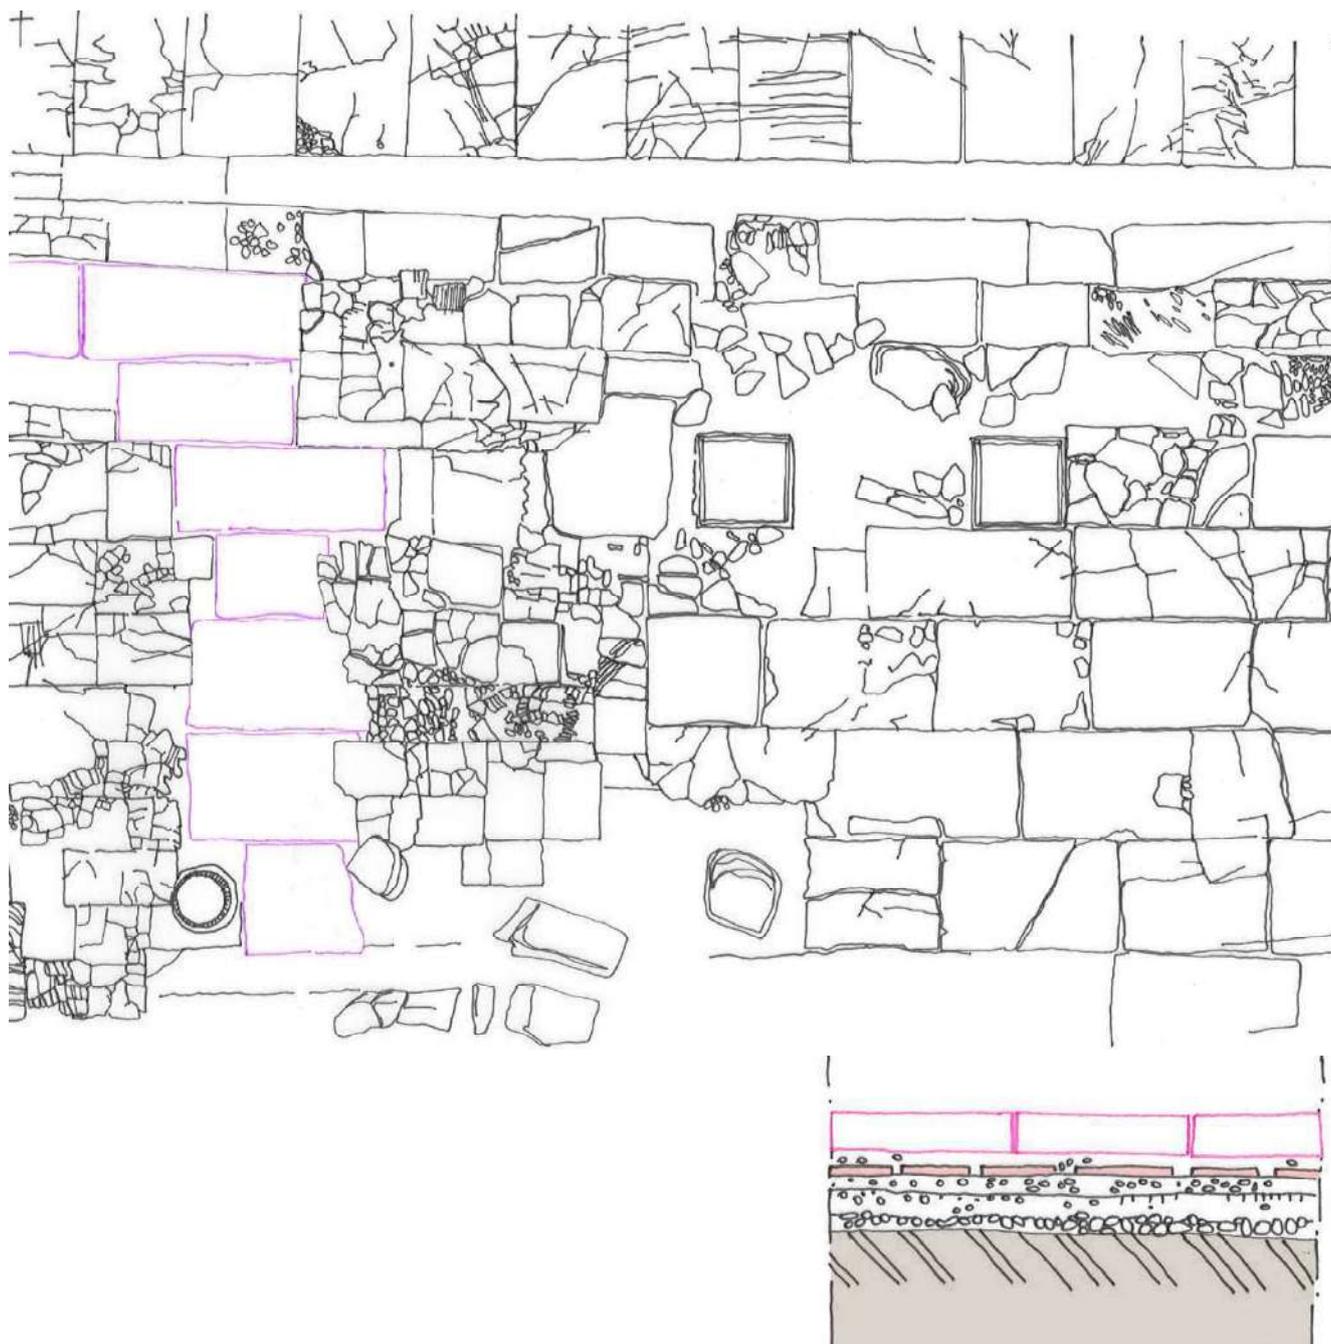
Ipotesi di pavimentazione con strato con strato superficiale costituito dal trattamento di depolverizzazione
